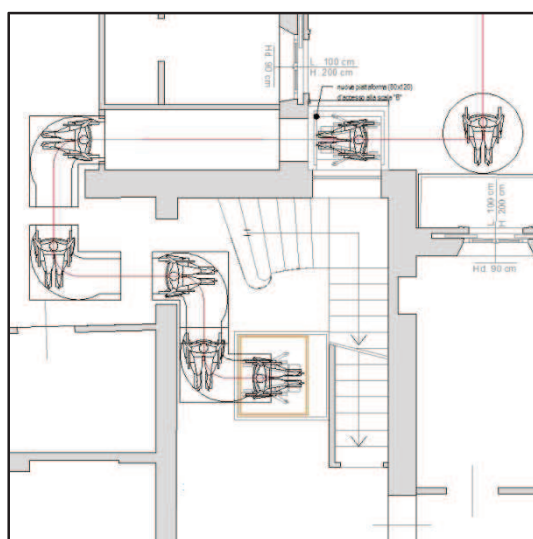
PARTICOLARE PIANTA ACCESSIBILITA' piattaforma elevatrice per accesso alla scala B
